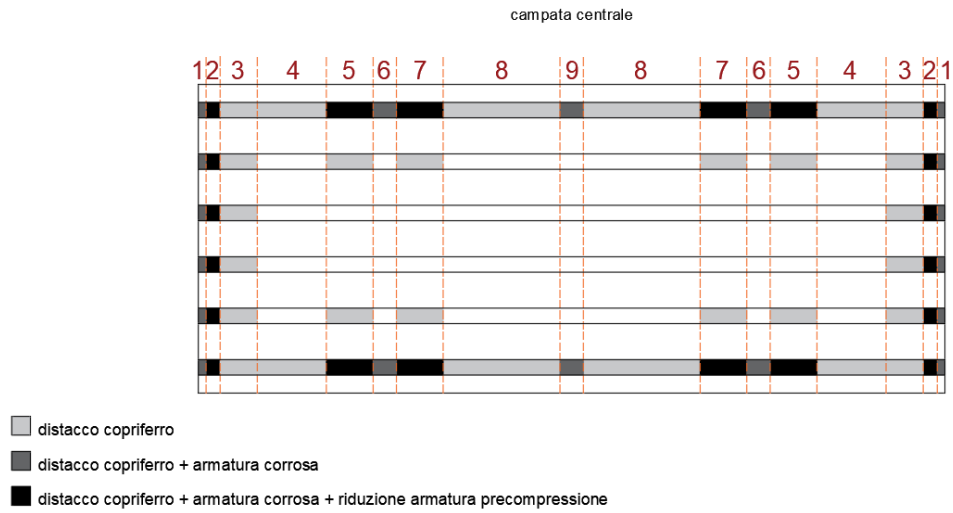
Ponte sul torrente Mavigliano, Caso I_ev3 schema deterioramento in pianta
